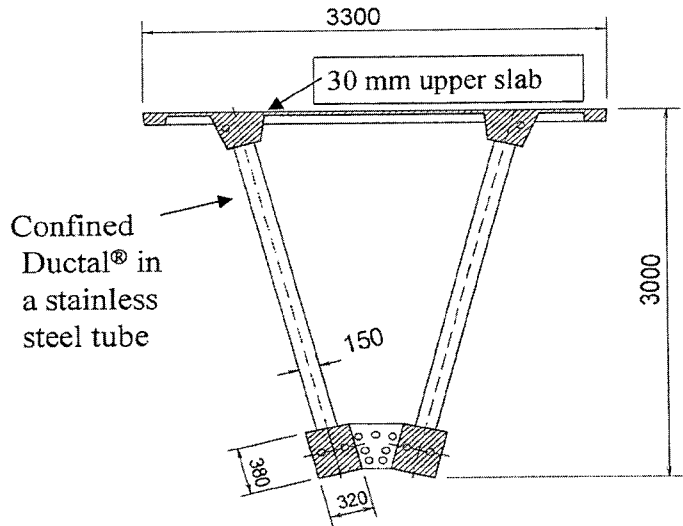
concrete filled steel tube의 적용 예 (Canada의 Sherbrooke 인도교)
